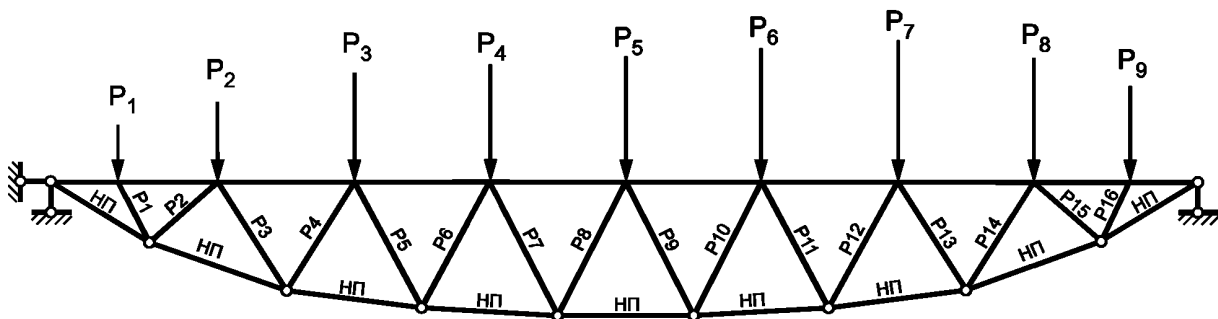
Расчетная схема деревометаллической фермы покрытия Крытого конькобежного центра
